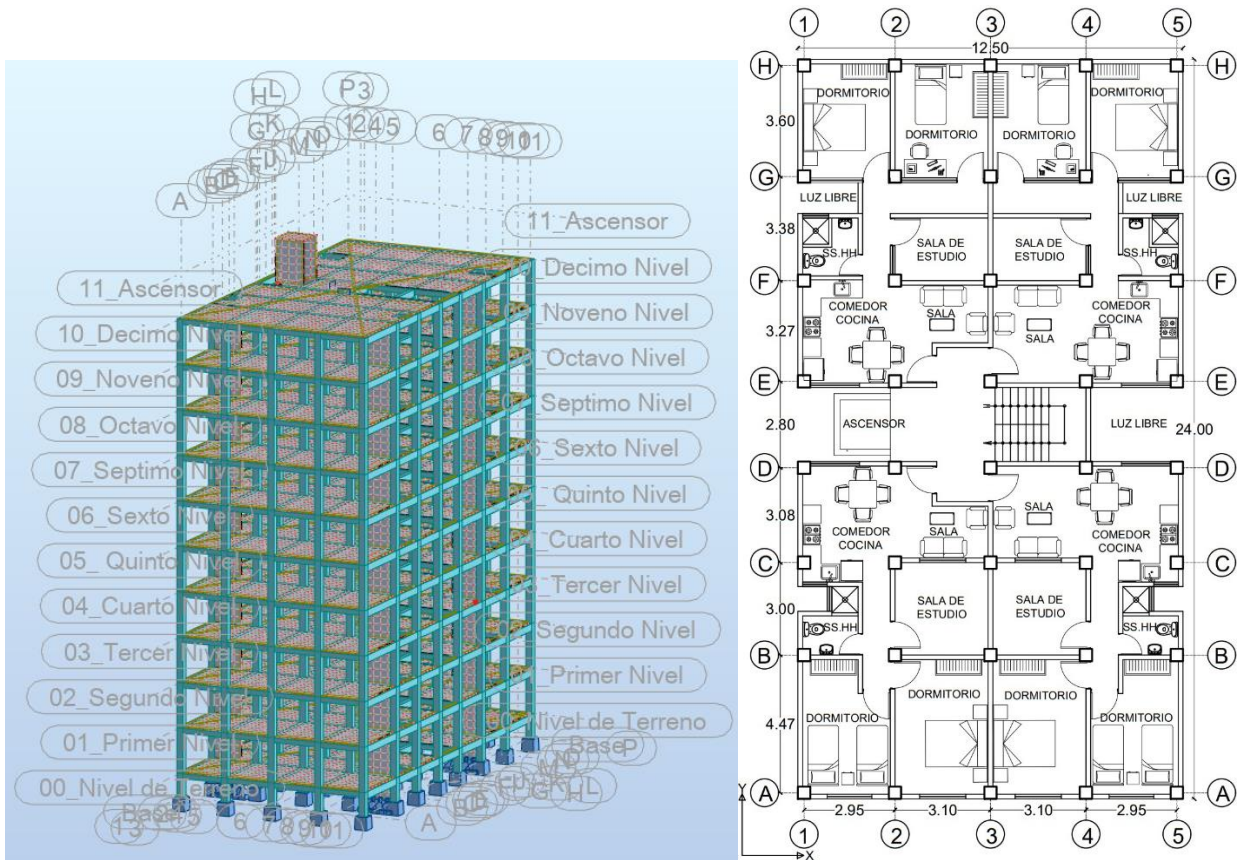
Vista en perspectiva (izquierda) y planta típica (derecha); dimensiones en metros (m).
